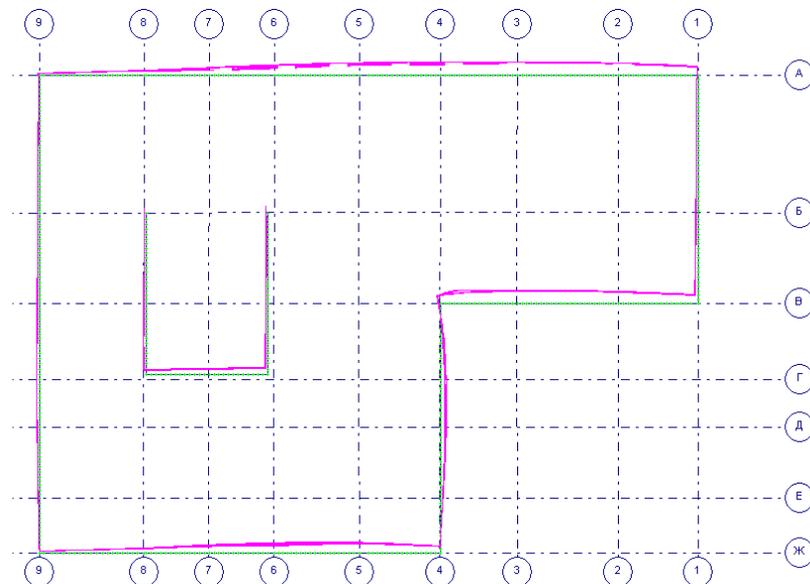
Деформированная схема стен здания при сейсмическом воздействии
